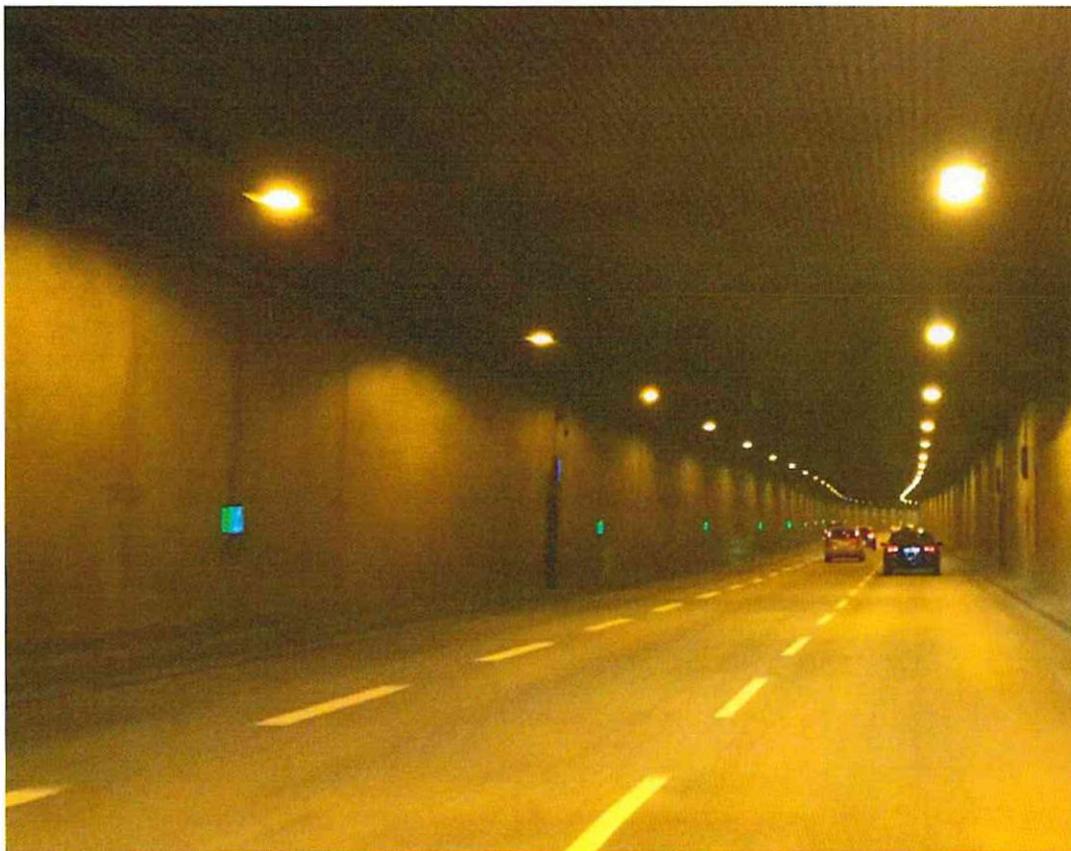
Tunnelmittelwand aus Beton ohne erkennbare Farb- und Brandbeschichtung
